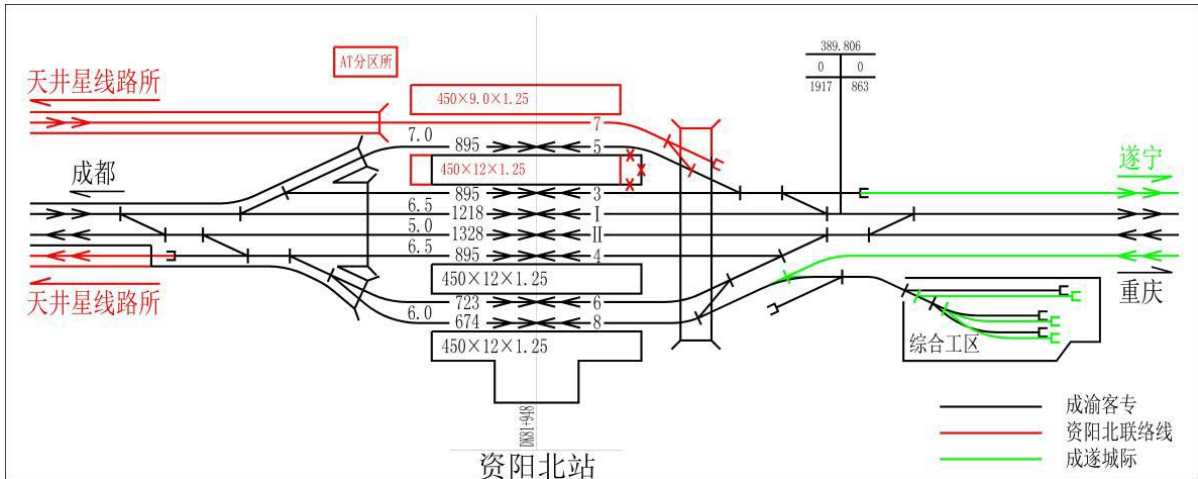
资阳北站布置示意图（资阳北支线接入后）
